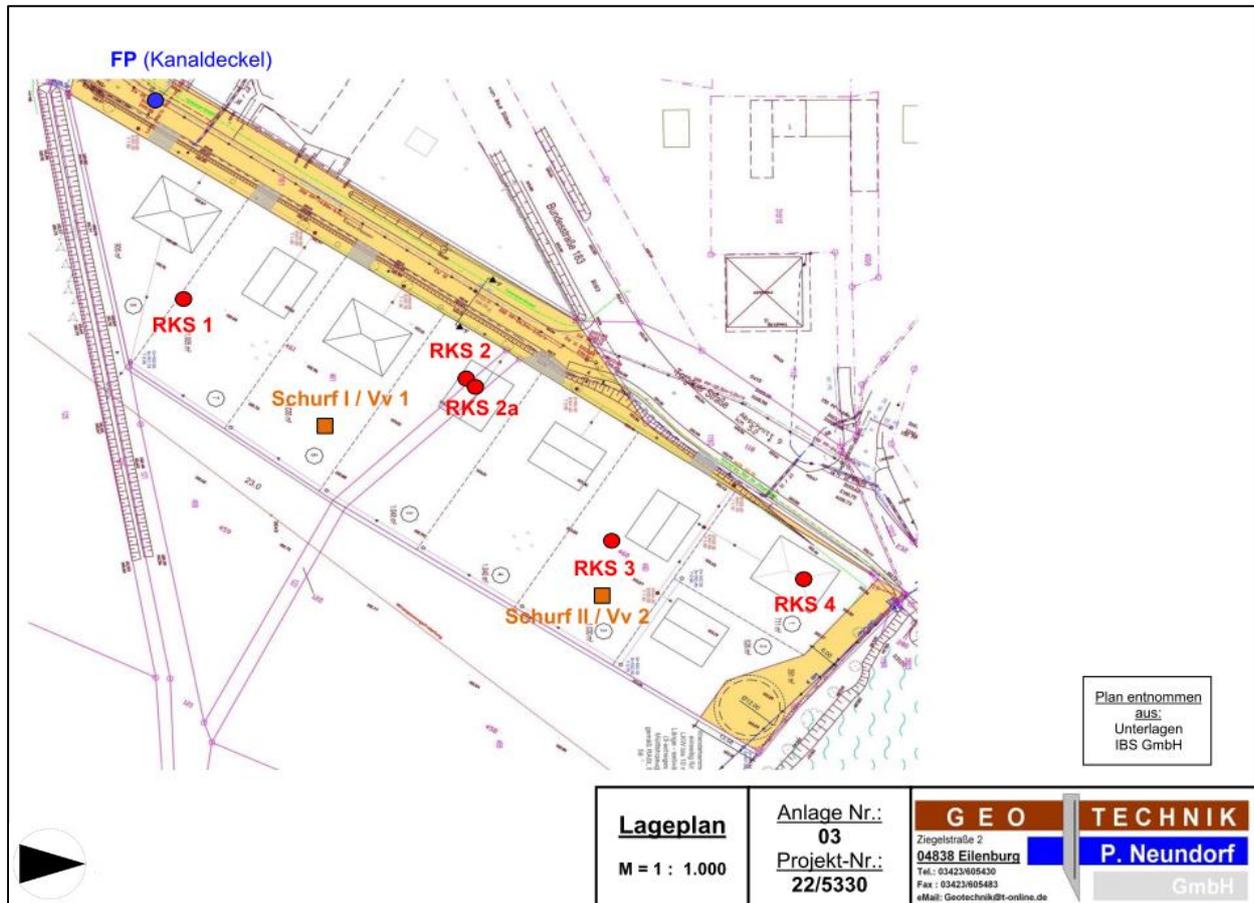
Lageplan Rammkernsondierungen im Vorhabengebiet (ohne Maßstab)
